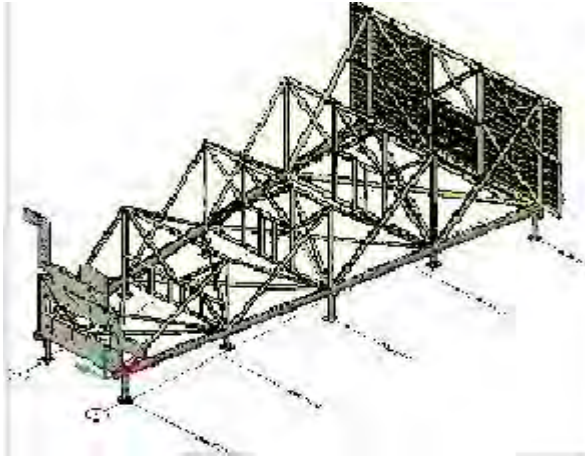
a.8. Gambar skema fabrikasi jacket tahap kedelapan
